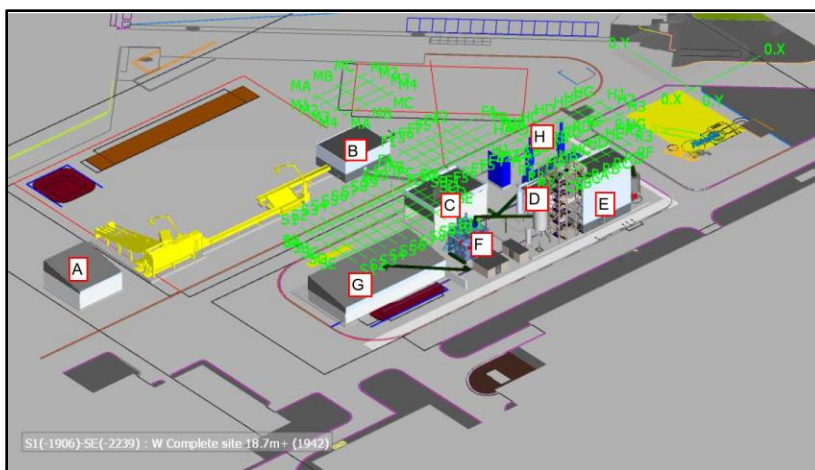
Schematische weergave van de gebouwen en installaties van de plant.
